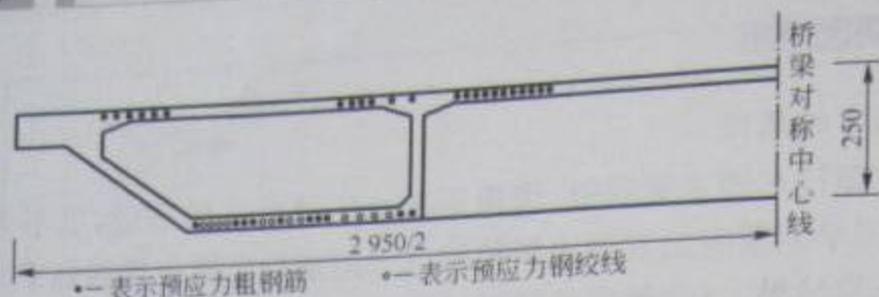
原主梁截面预应力筋布设(尺寸单位:cm)
